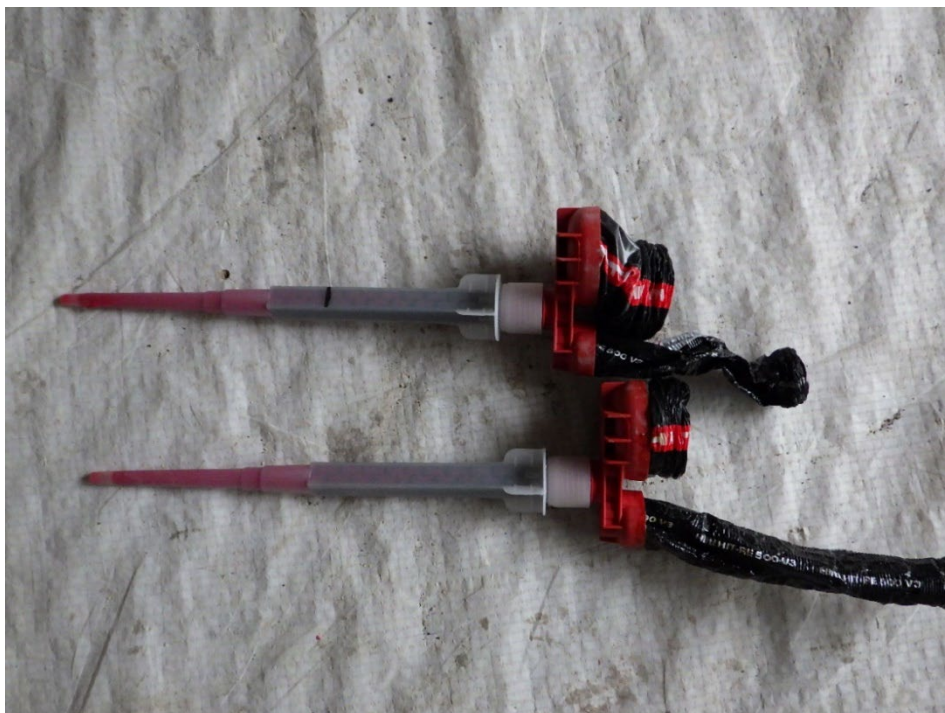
あと施工アンカー施工後試験における空缶数量の状況, 2本
